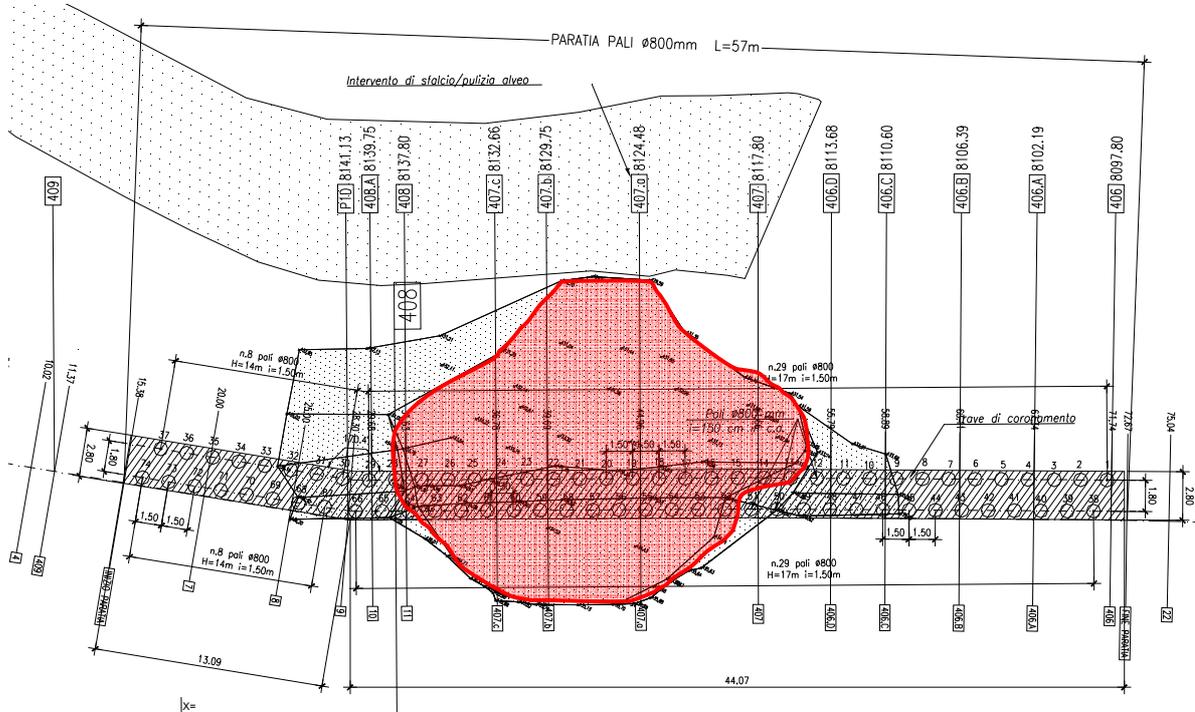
Planimetria di progetto. In rosso l'ingombro del dissesto
